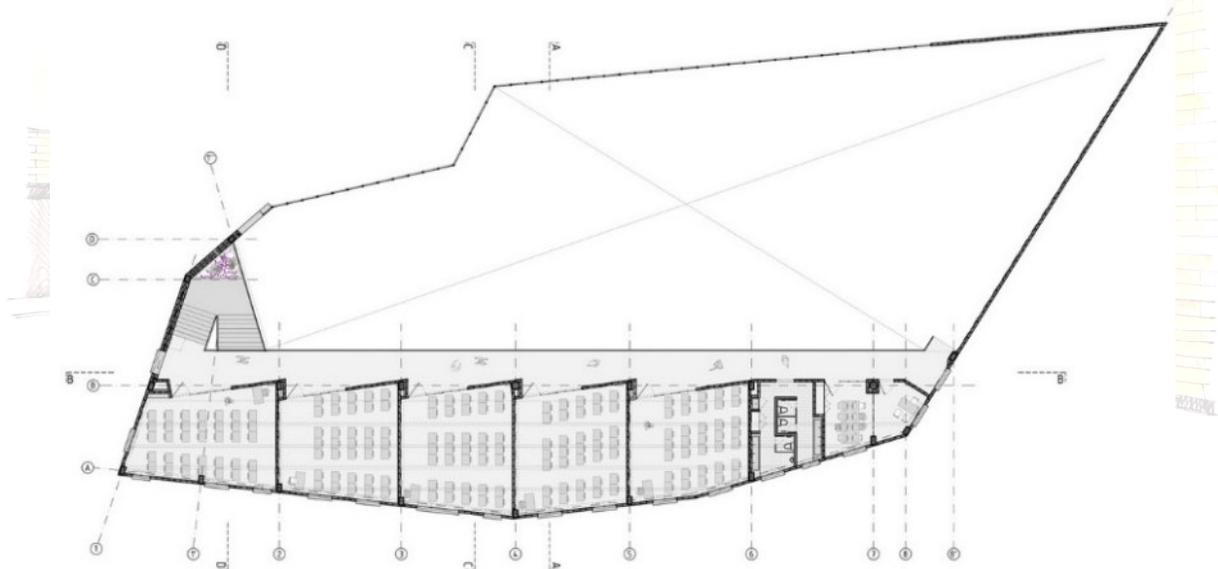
/ Institución Rural Chaparral/ Planta Alta Arquitectura/ Año 2015/ Obtenido de PlanB Arquitectos
